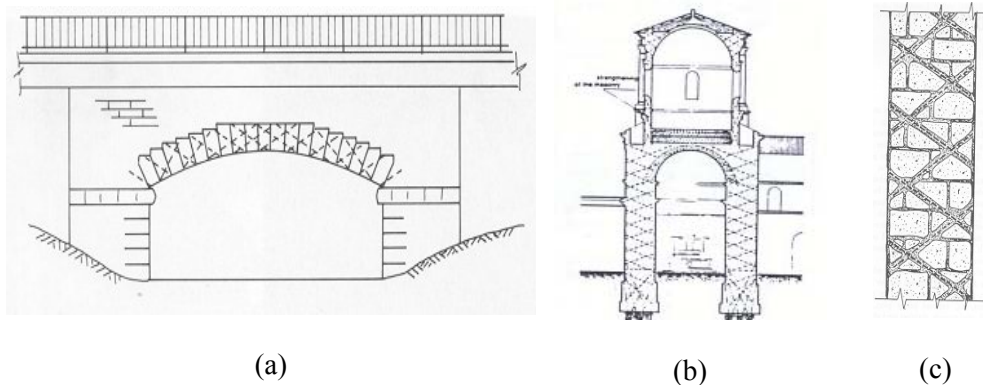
Exemplos da aplicação de pregagens generalizadas em elementos estruturais: (a) arco de uma ponte; (b) e (c) reforço de paredes mestras (secção transversal).
